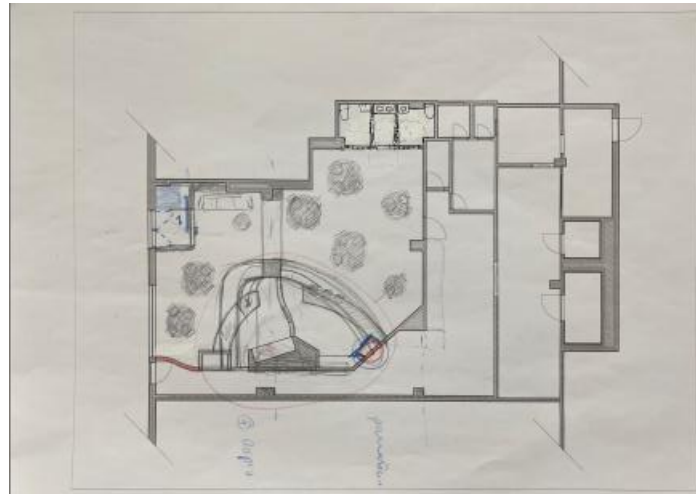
Planta de estudo 2. Fonte: Autora, 2025
